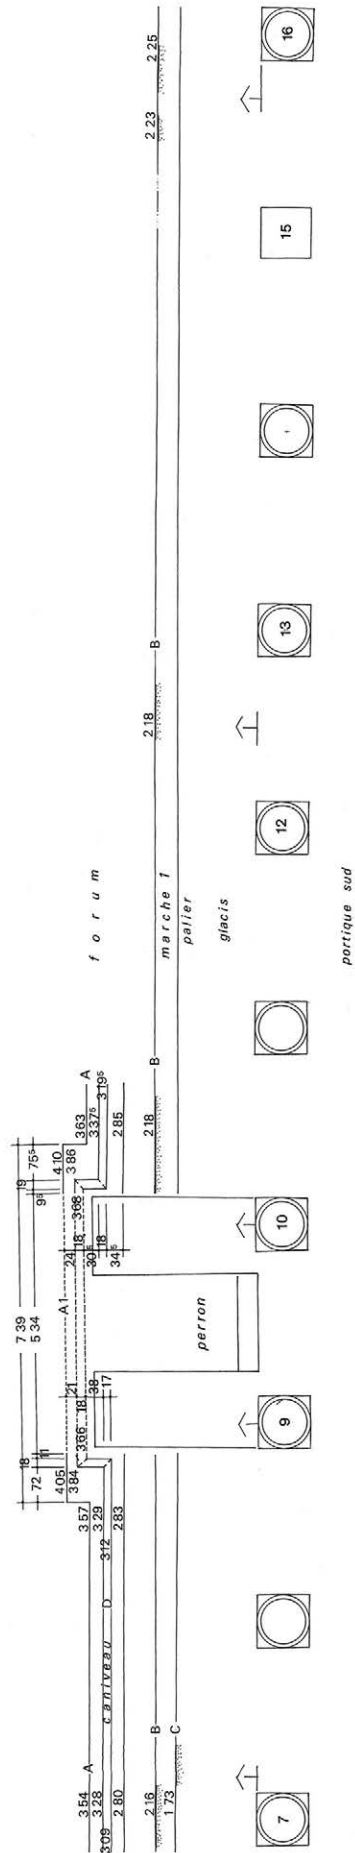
Embranchement et brisures du caniveau devant les colonnes 7 à 16 et le perron sud (G. Hallier).
